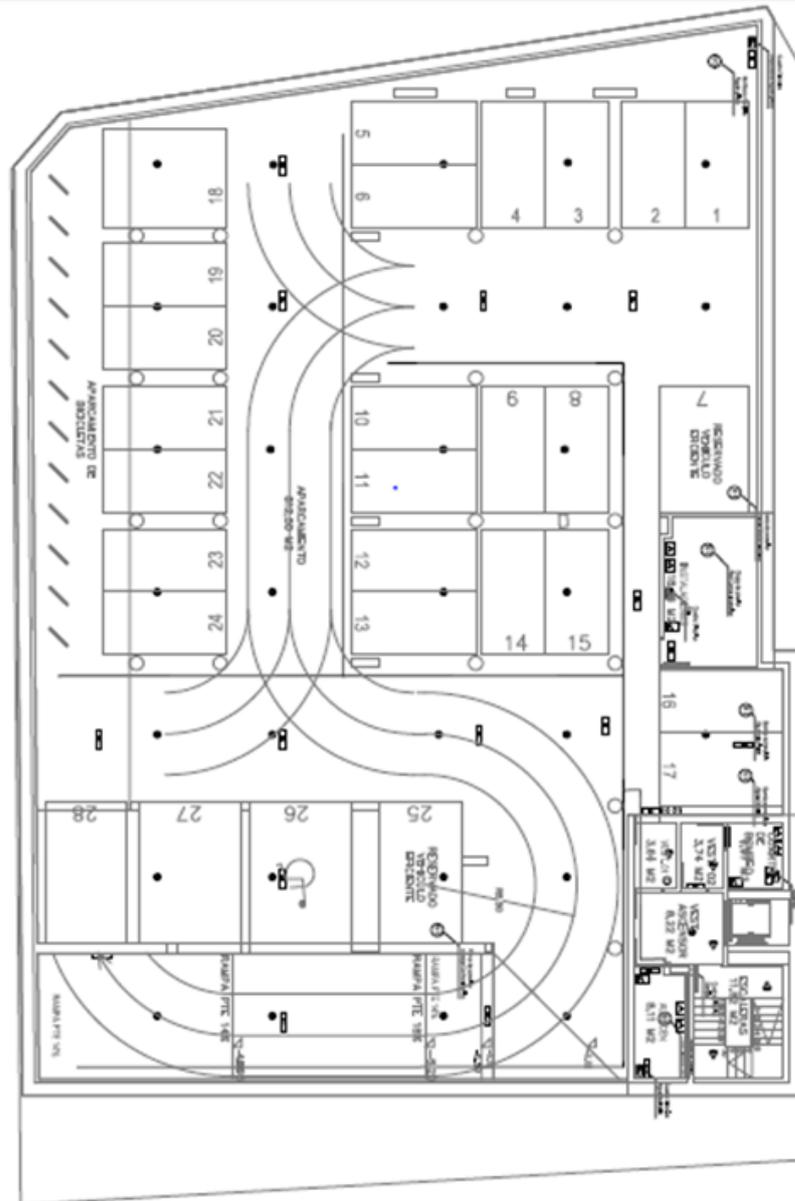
Plano planta aparcamiento modelo (Fuente: [25])
